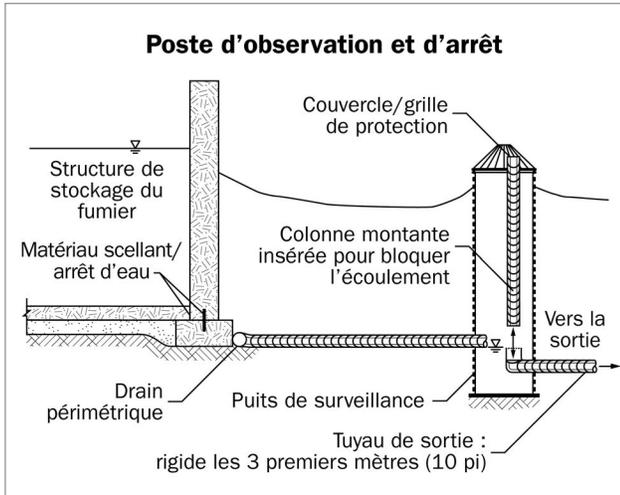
Un poste d'observation et d'arrêt permet d'accéder au drain de périmètre, au besoin, et de bloquer tout écoulement contaminé.
